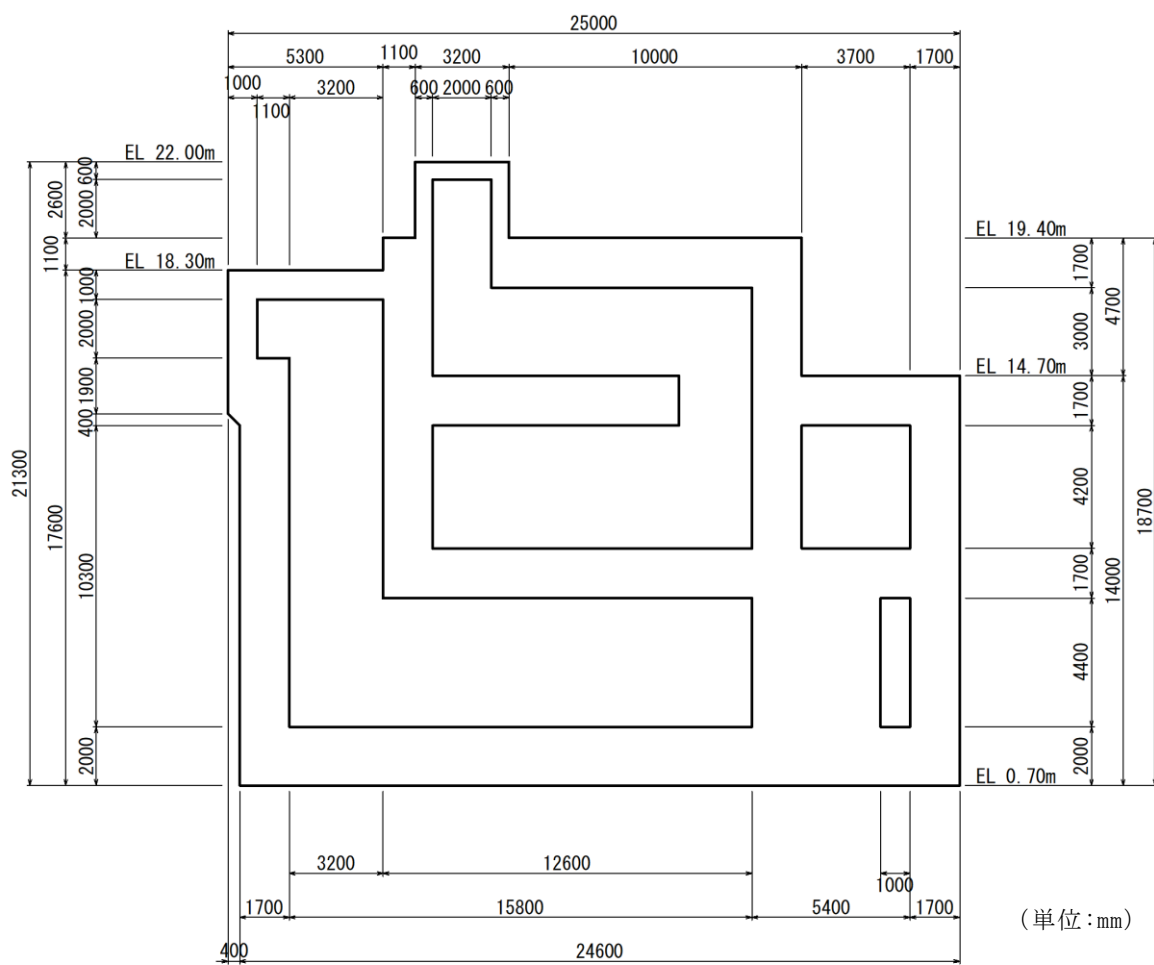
(6) 第1 ベントフィルタ格納槽 断面図 (F-F 断面)
